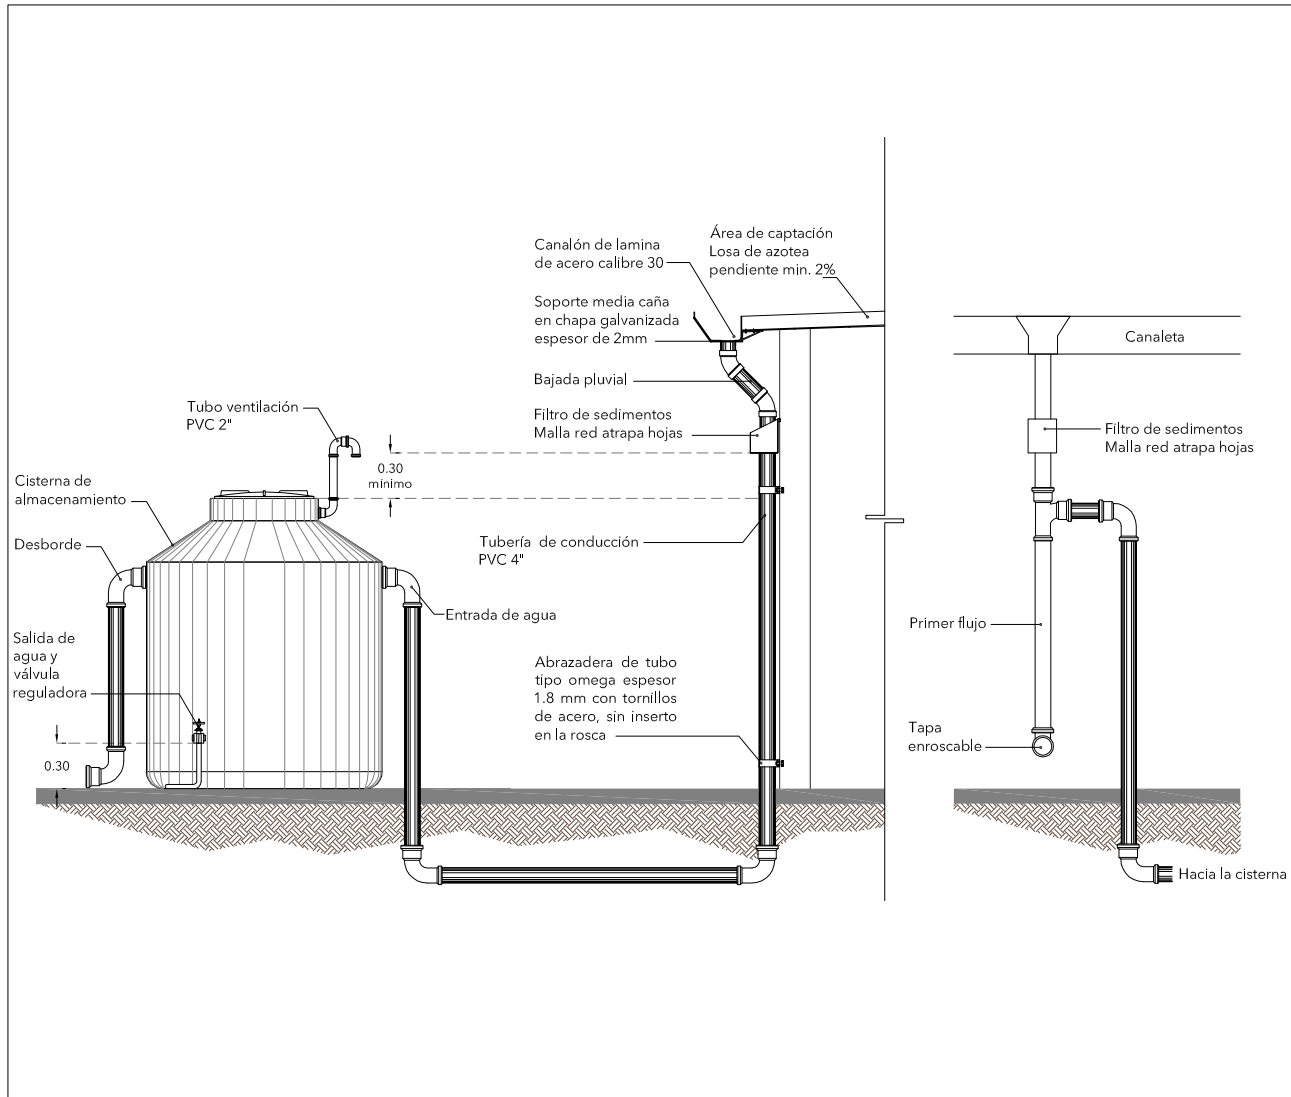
Detalles constructivos de Cisterna, sistema húmedo
